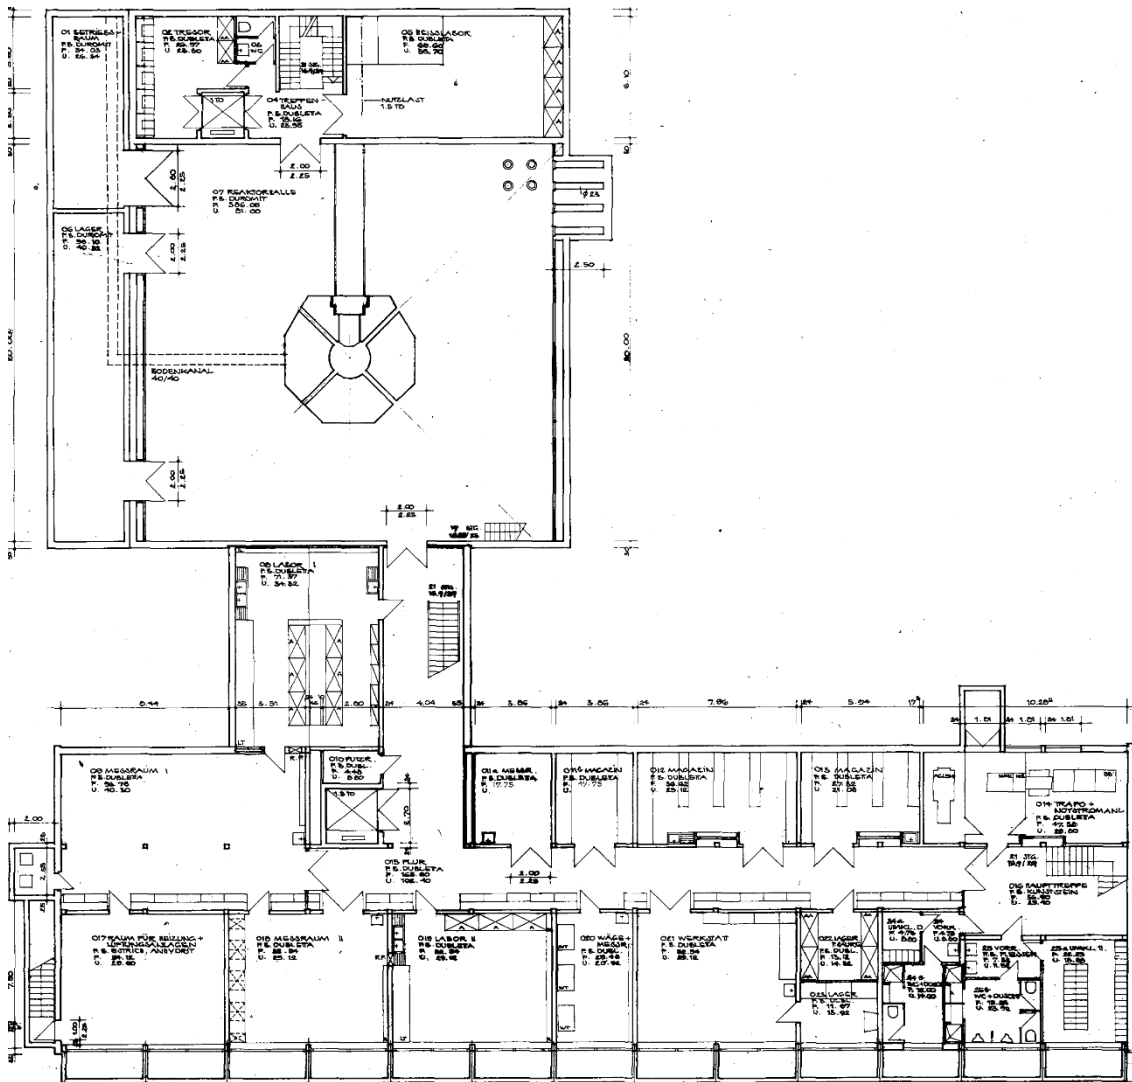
Grundriss Erdgeschoss des FRMZ /MEN 62/
